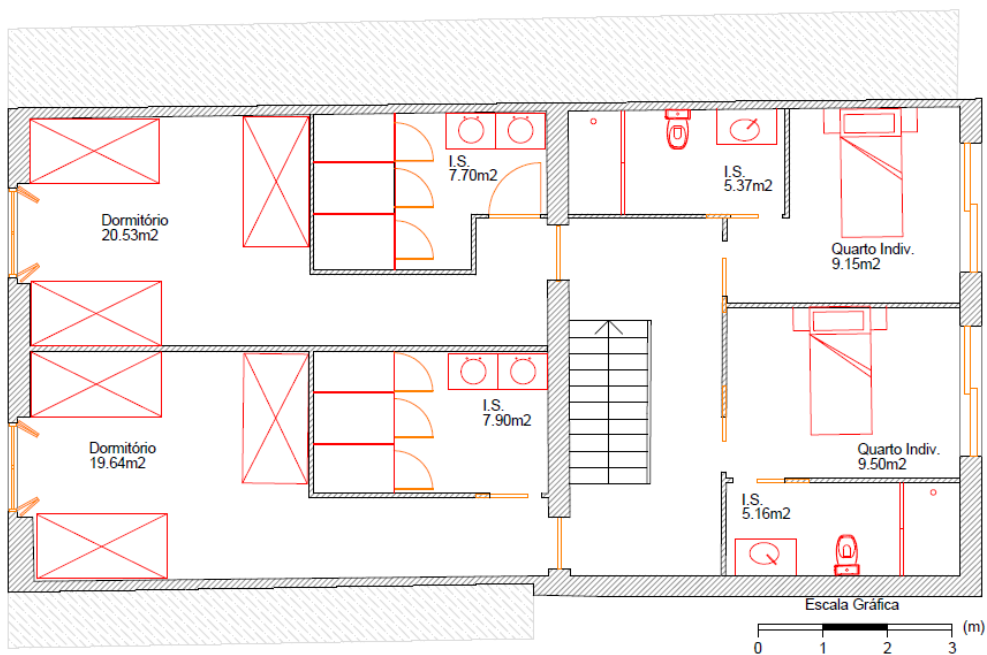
Planta do Piso 2 do Edifício Reabilitado
